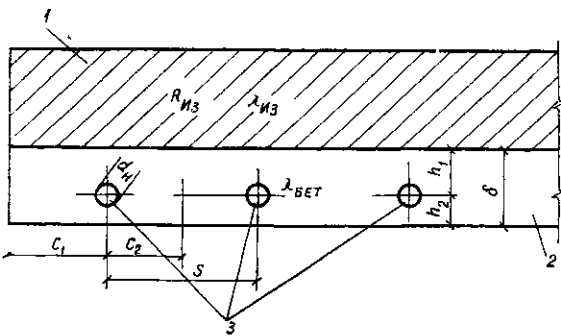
24 Расчетная схема сплошной железобетонной плиты перекрытия
